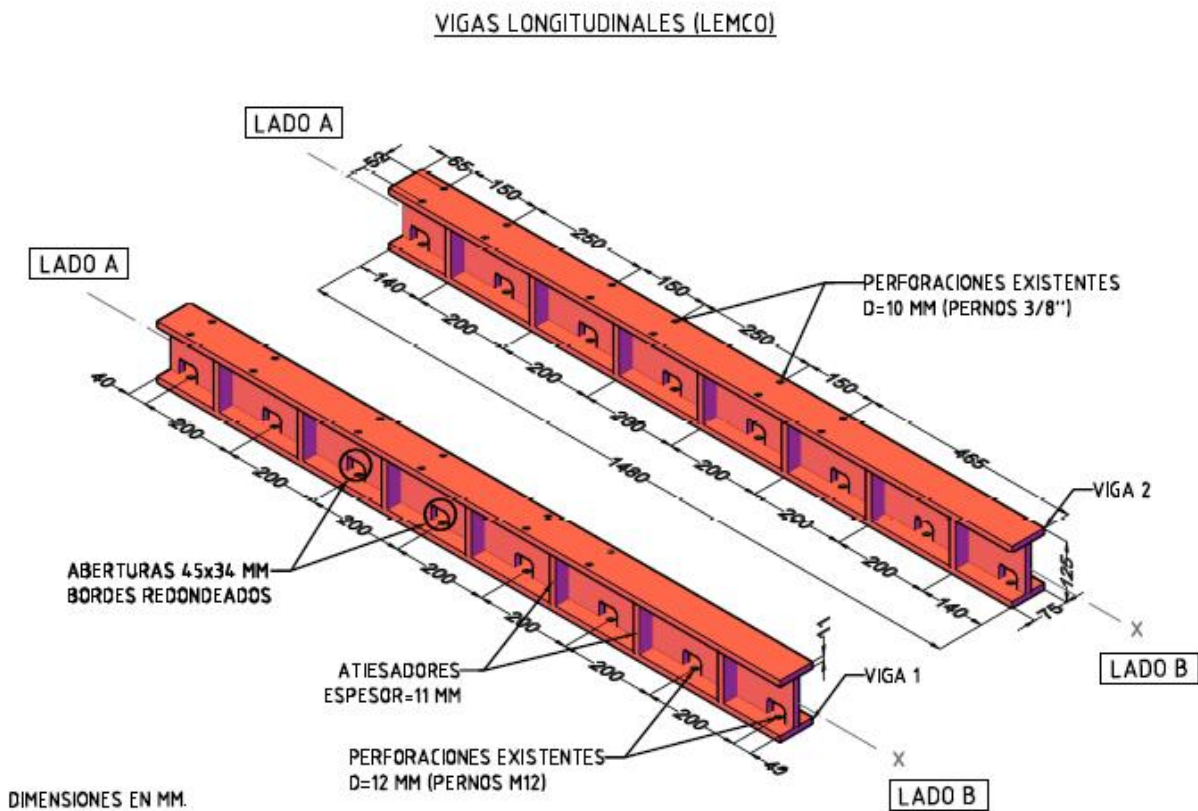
Vigas de Acero disponibles en LEMCO.
